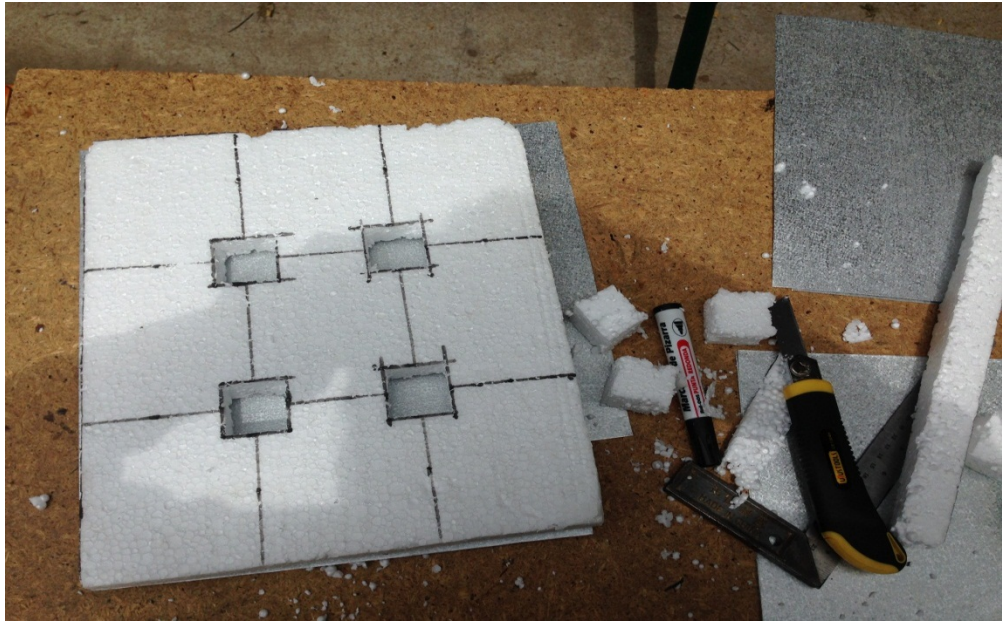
Corte de agujeros en planchas de poliestireno expandido. Fuente: Elaboración propia, 2016.
